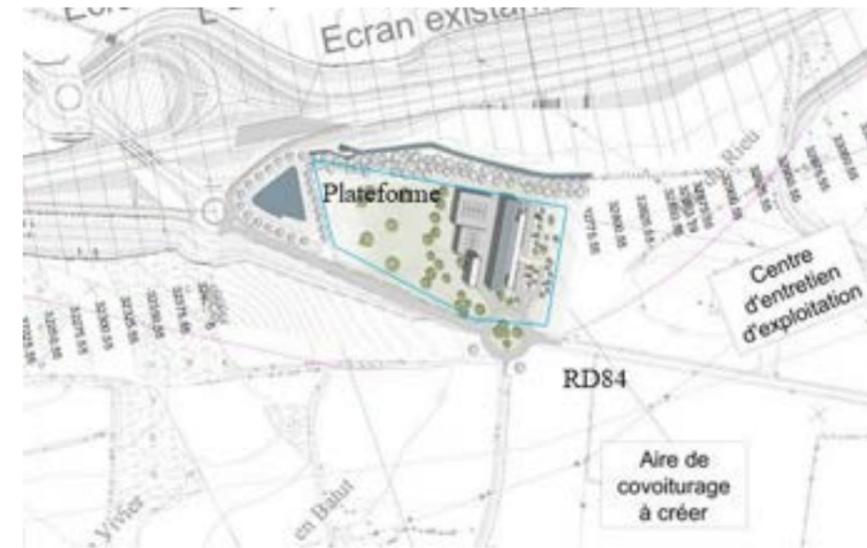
Plan masse du CEI et de la plateforme apte à accueillir la Gendarmerie
